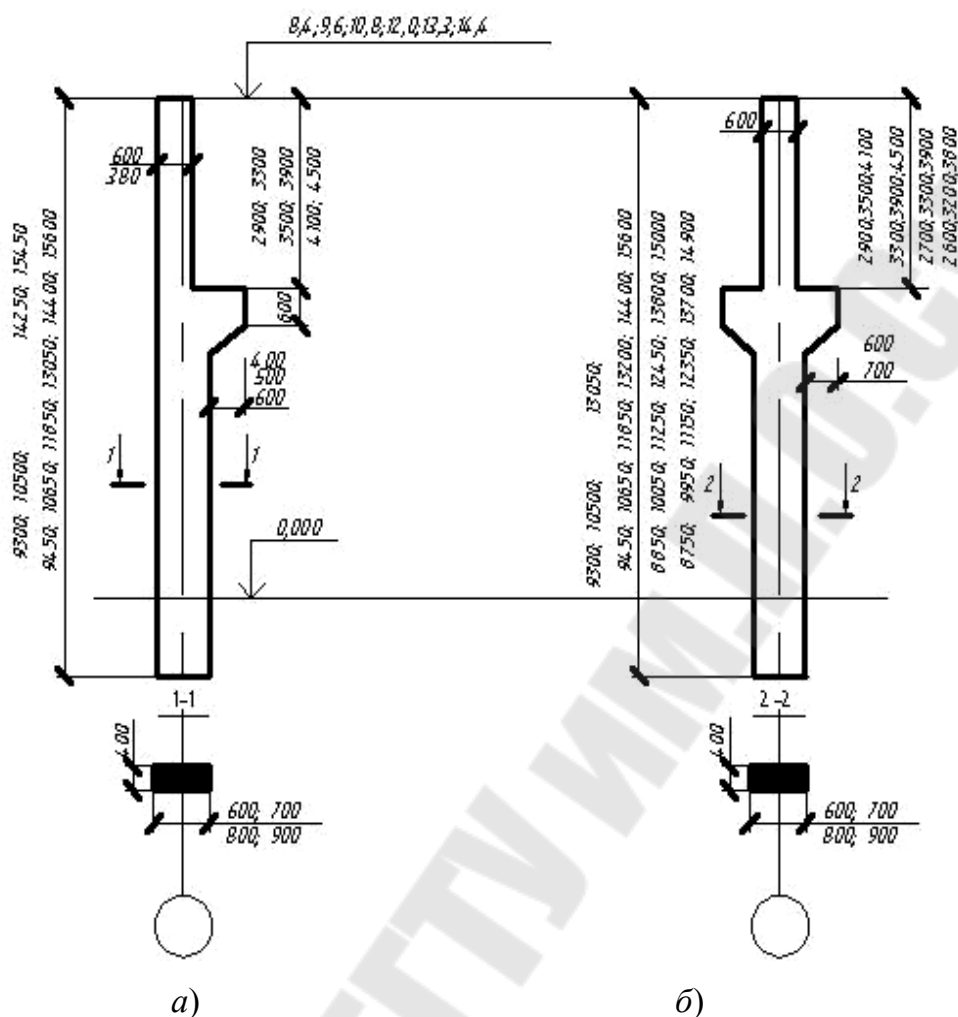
Железобетонные колонны для здания высотой до 14,4 м оборудованные кранами:
